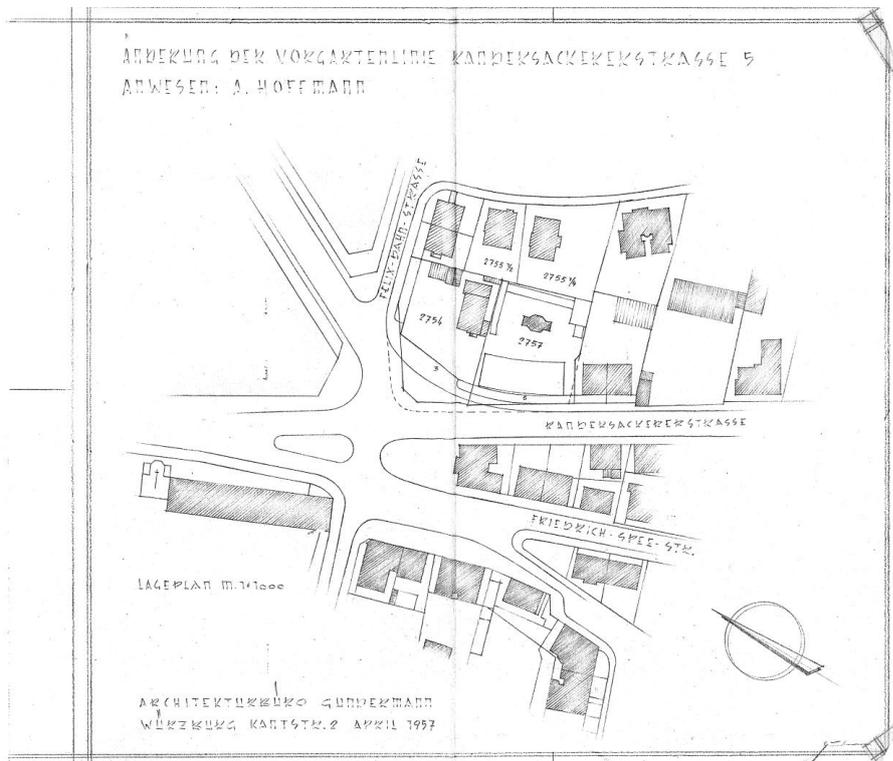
Lageplan, Architekturbüro Karl Gundermann mit zweigeschossigem Ladengeschäft in der Randersackerer Straße 3, 1957.
